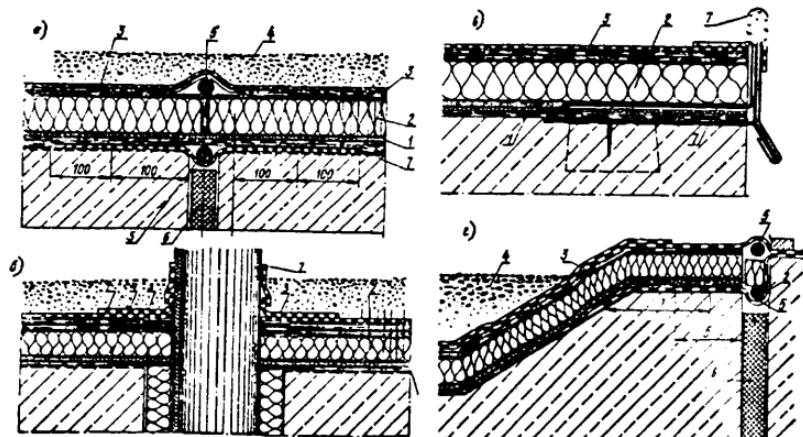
Конструкции утепленных и защищенных кровельных покрытий:
